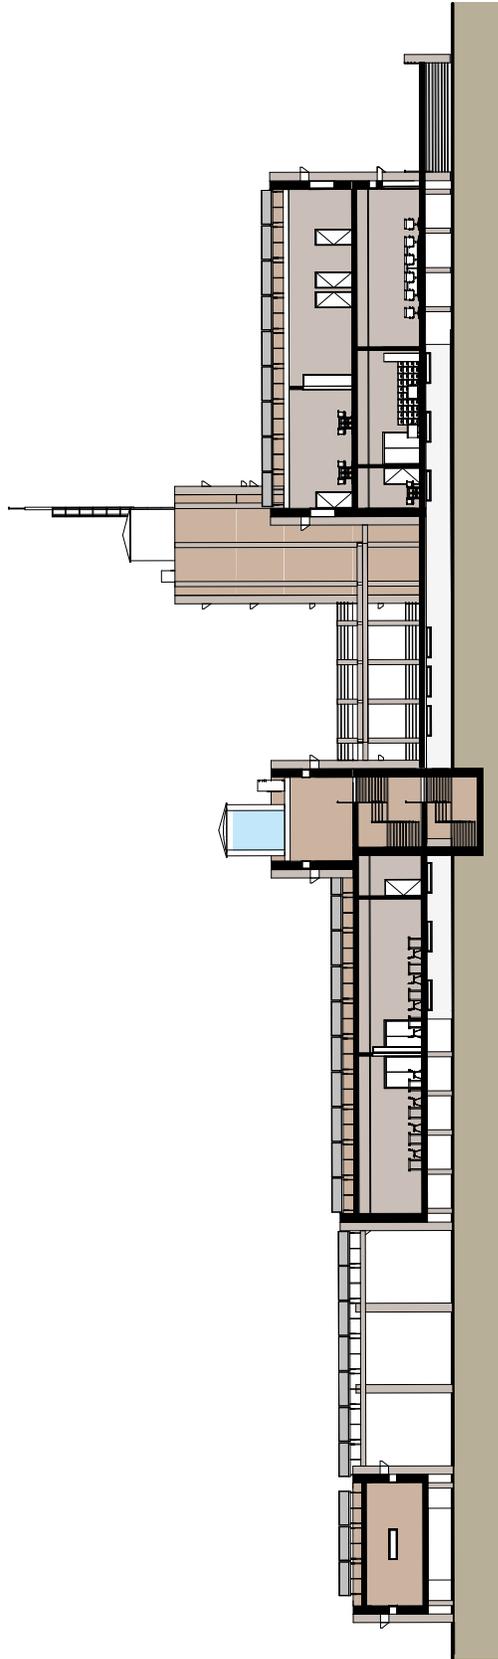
Corte Longitudinal (Fuente: elaboración propia)
